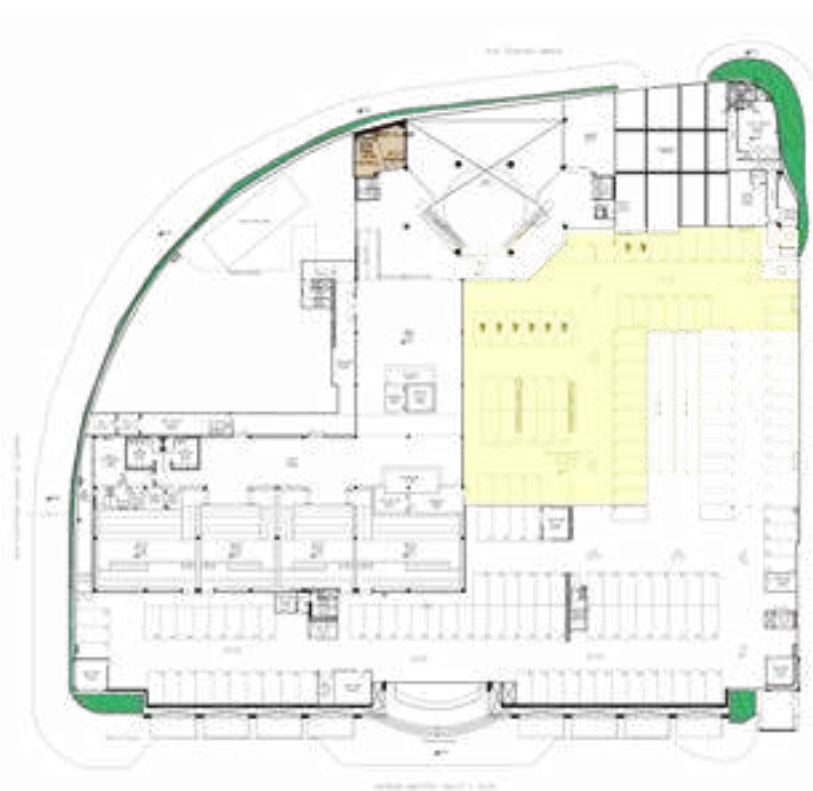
PLANTA BAIXA DO G3 COM A ZONA A SER RESTRUTURADA.
